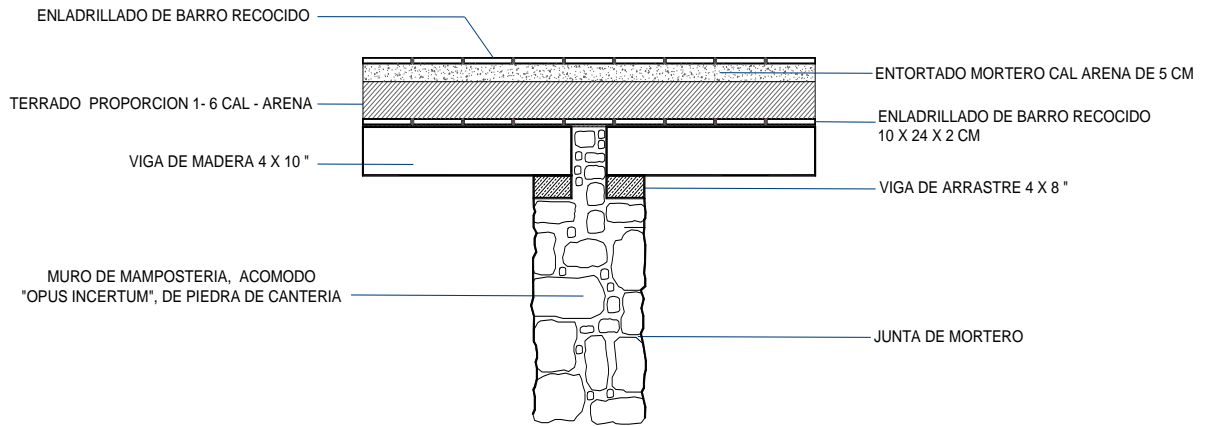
Detalle No. 3 vista de corte de la cubierta mostrando la vigería, el enladrillado y el terrado.
